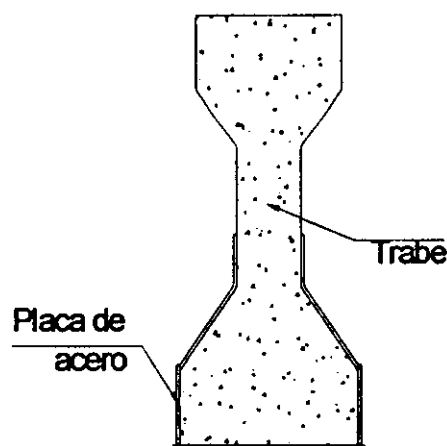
Disposición de refuerzo mediante placas de acero adheridas
